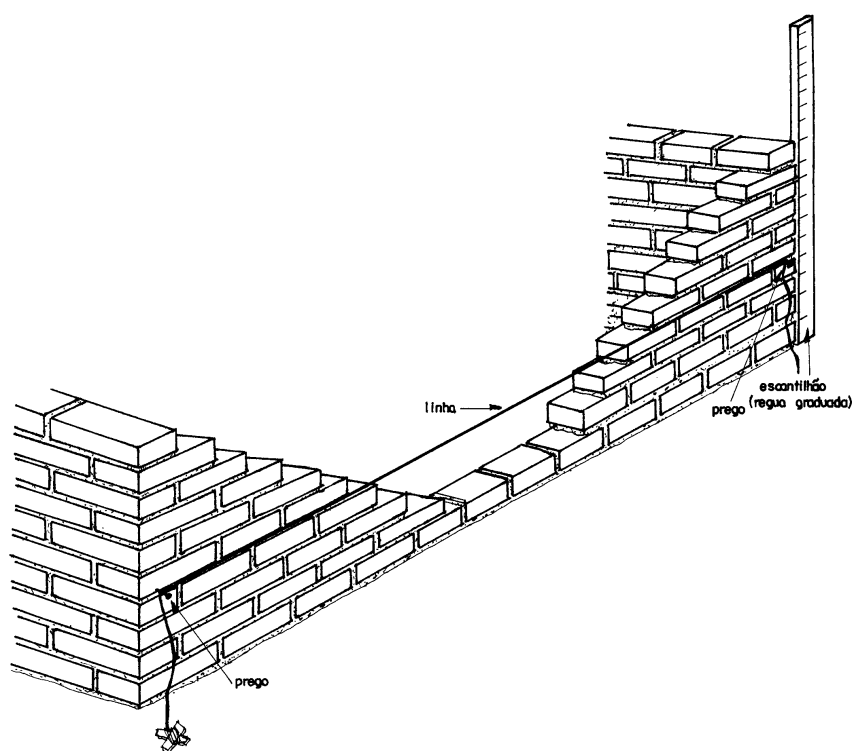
Detalhe do nivelamento da elevação da alvenaria.
